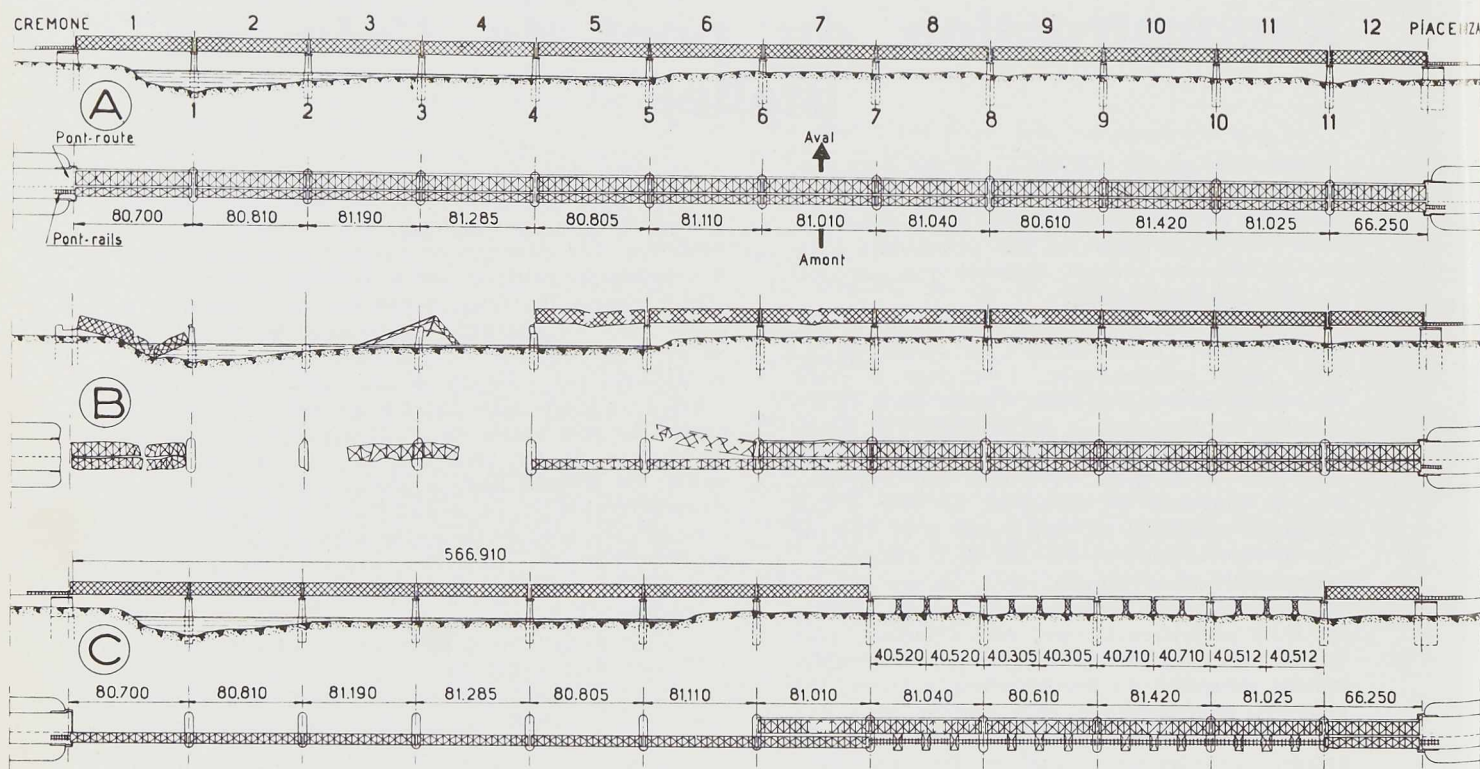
Pont de Crémone sur le Pô. Elévation et plan :
